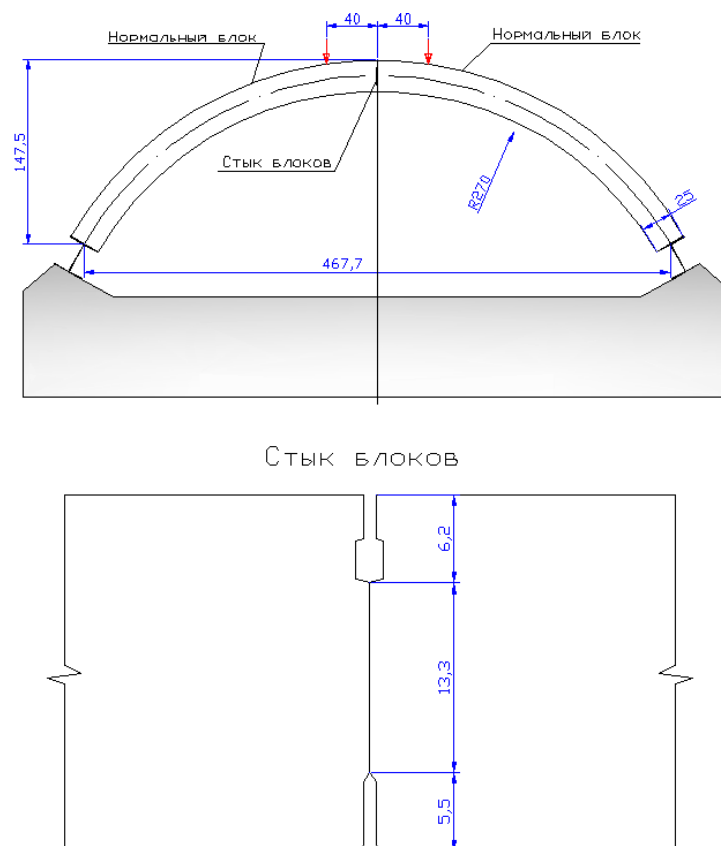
Схемы испытаний фрагментов обделки на стенде.
